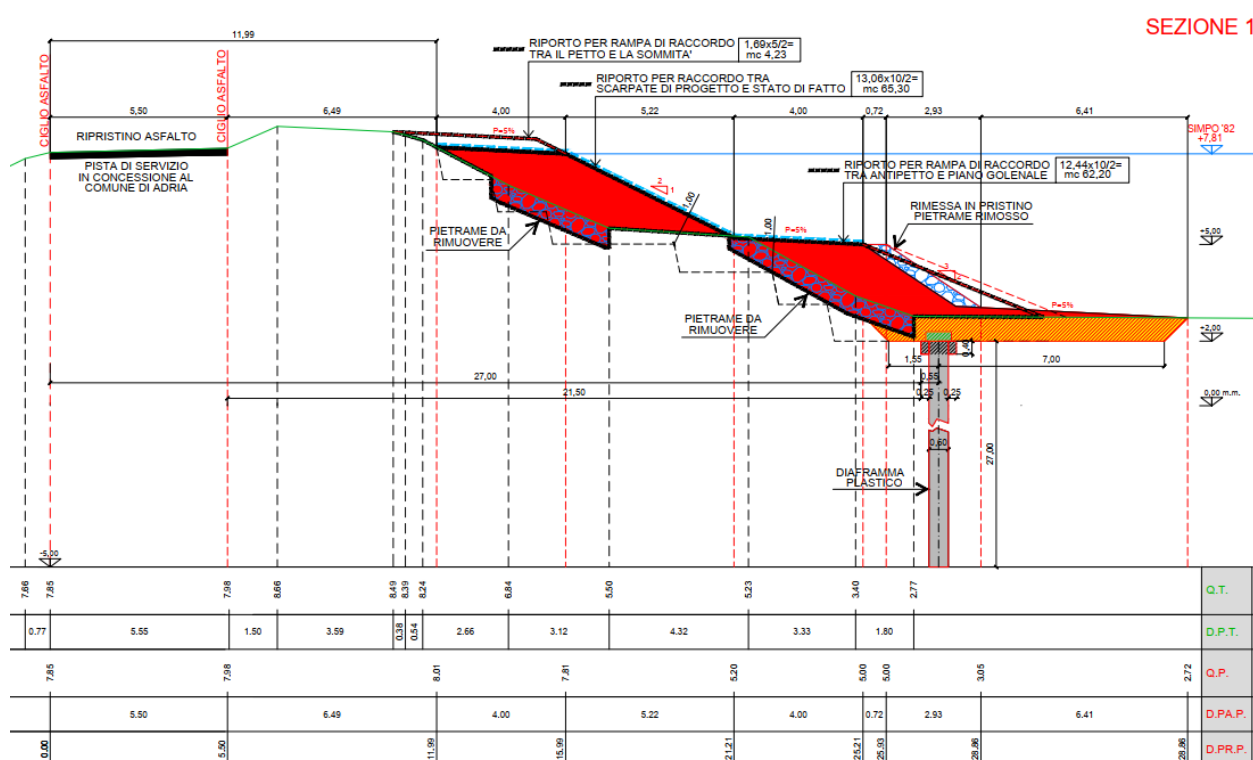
ex Sezione n.9 – Sezione 1 – 1° stralcio
